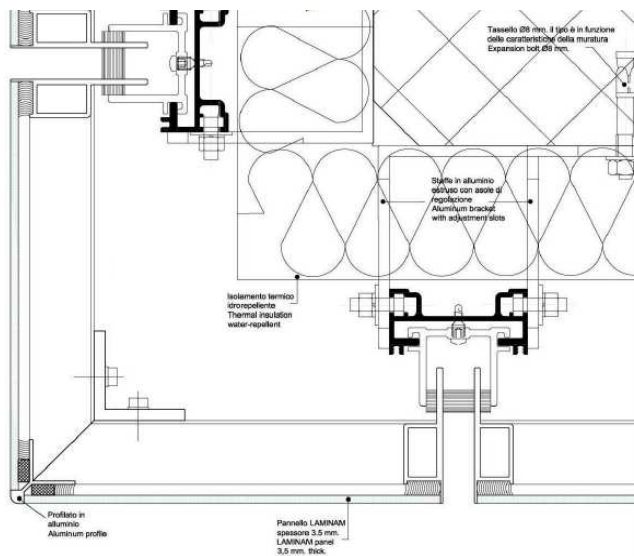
Fachada Laminam - Seção horizontal: detalhe perfis.
